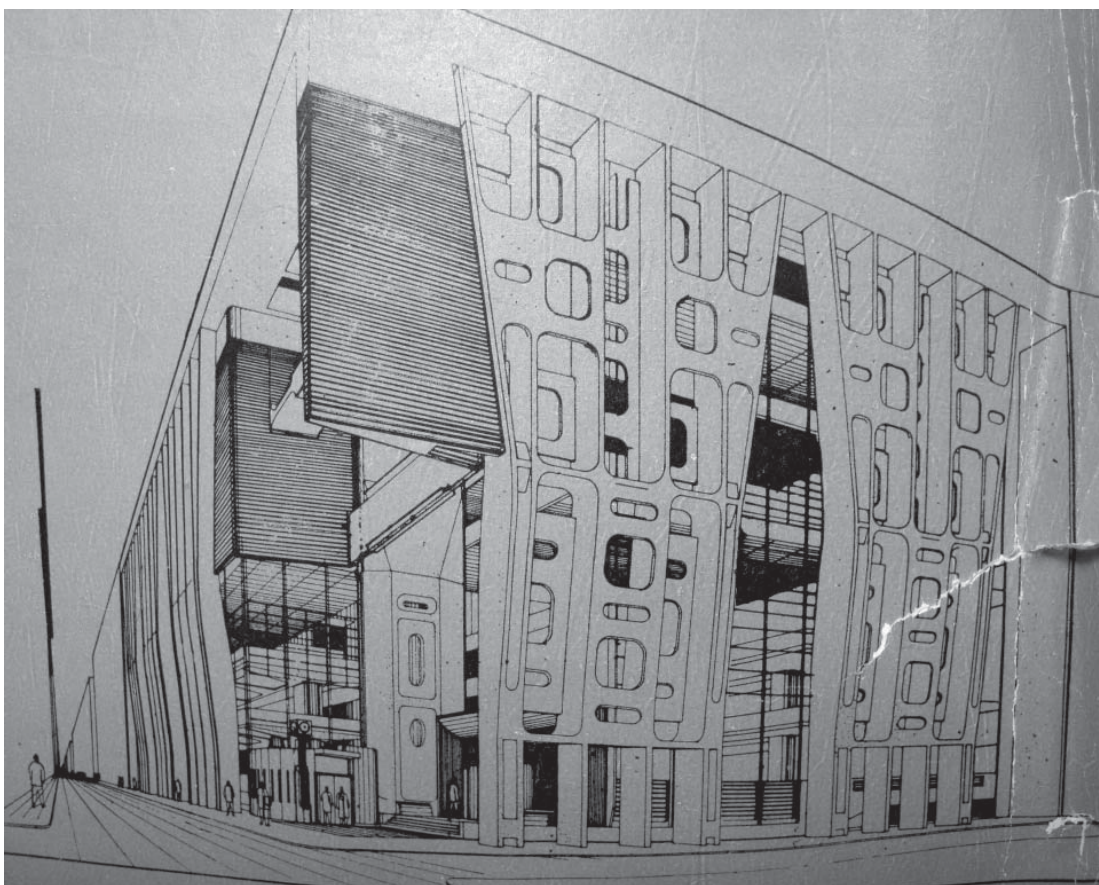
Banco de Londres, perspectiva externa. (Fonte: Construcciones. n.191, 1964.)
